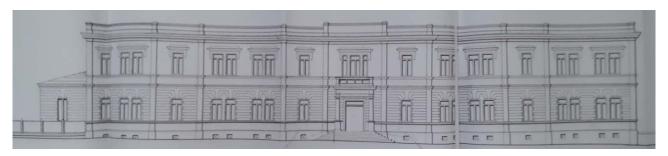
Prospetto Frontale (Stato di fatto ante ampliamento 1969)
